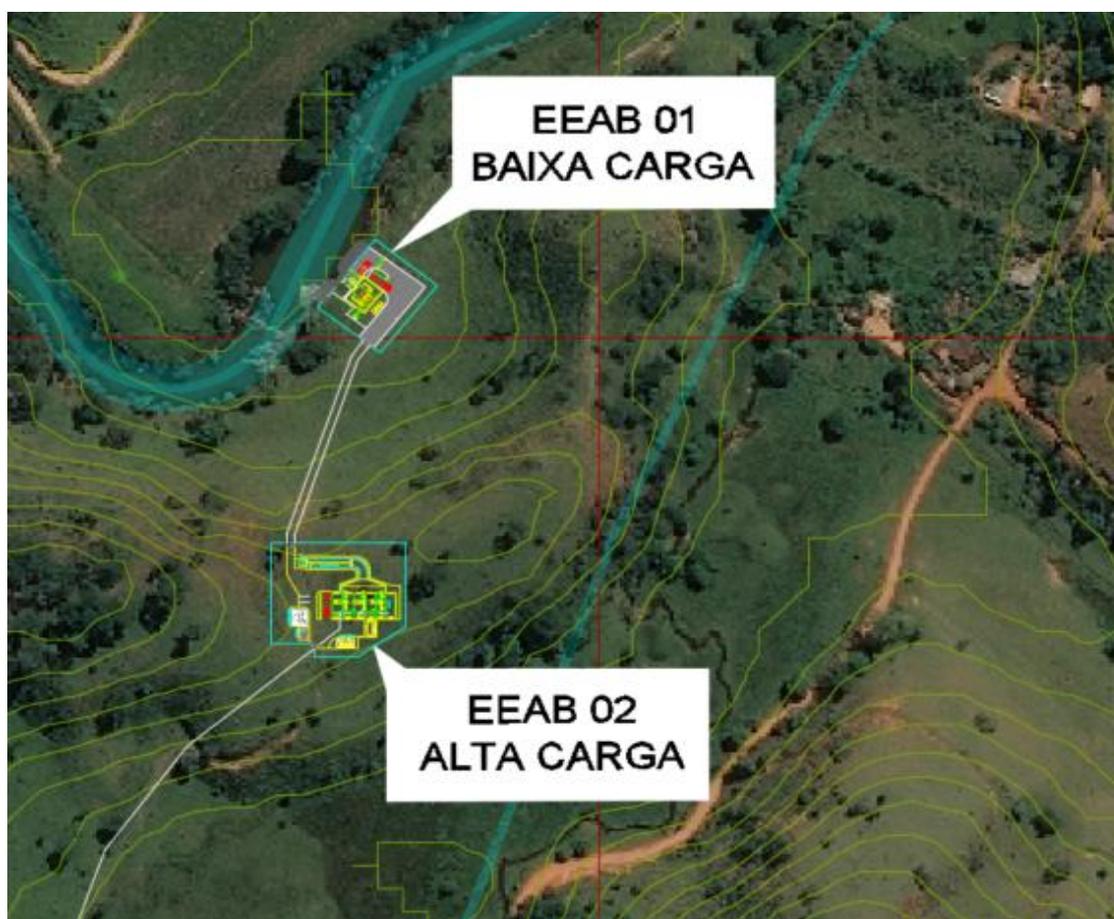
Layout – Conceitual para novo Sistema. Fonte: Arcadis (2021)
